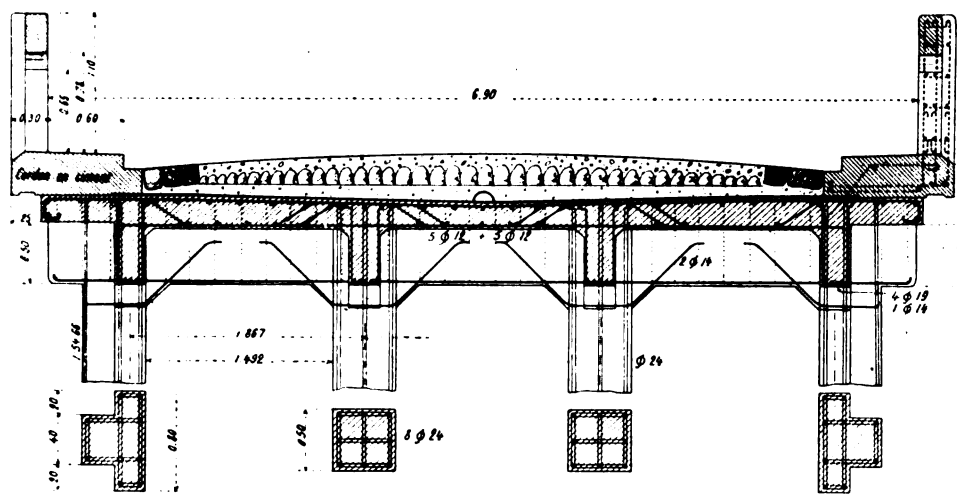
Viadotto in cemento armato sul Sitter - Sezione trasversale della carreggiata.
